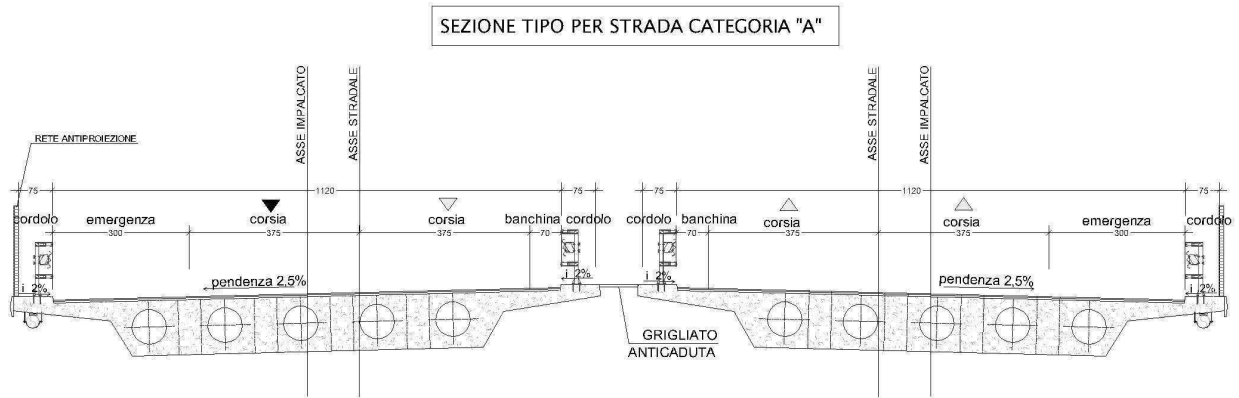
Sezioni stradali tipo su viadotto
